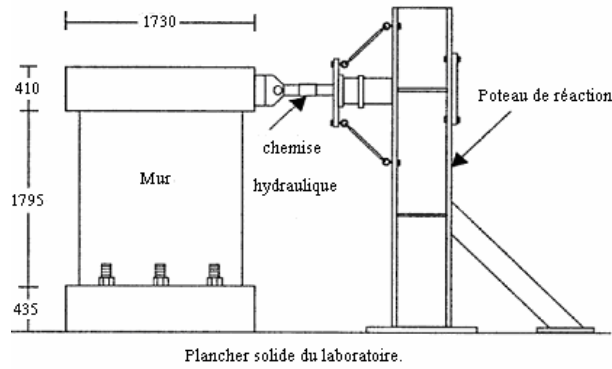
Mise en place des essais sur un mur de contreventement.[3]
